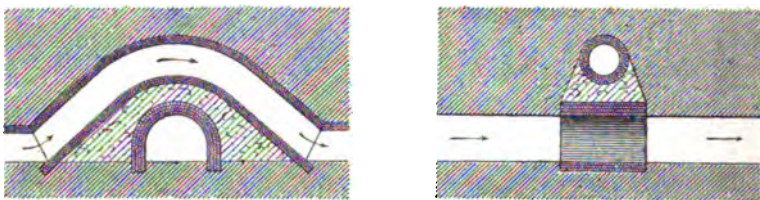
et 660. Crossing de Llwynpia (coupes verticales en long et en travers).
